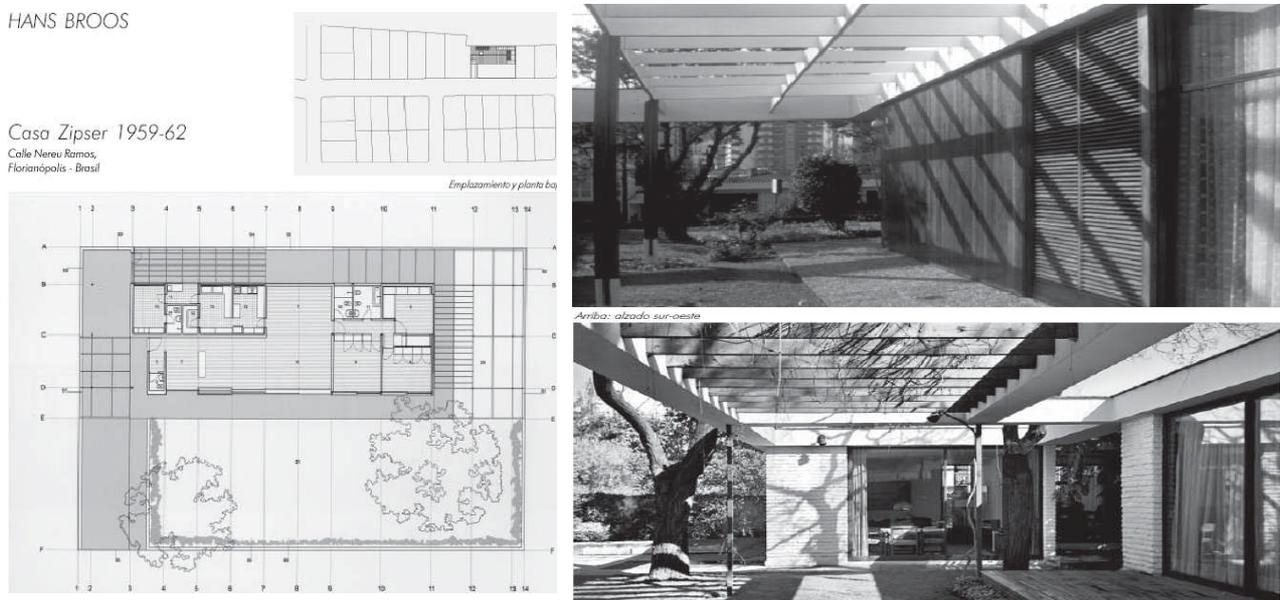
Casa Zipser 1959-1962 Brasil. Tomado del Libro *Arquitectura Moderna en América Latina*. Se muestra detalles de planta y espacios de exteriores de la vivienda.
